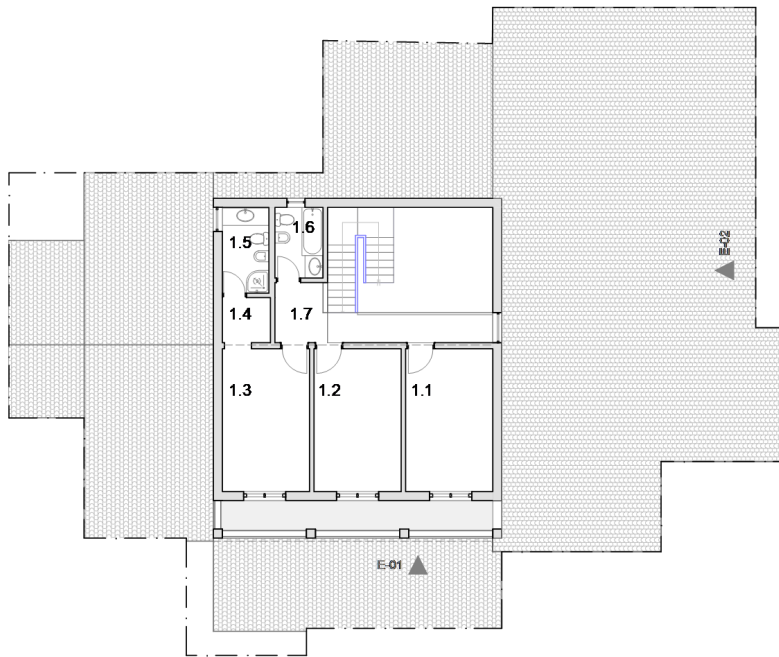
Planta Piso 1. Escala: 1:200 Fonte: Autor
